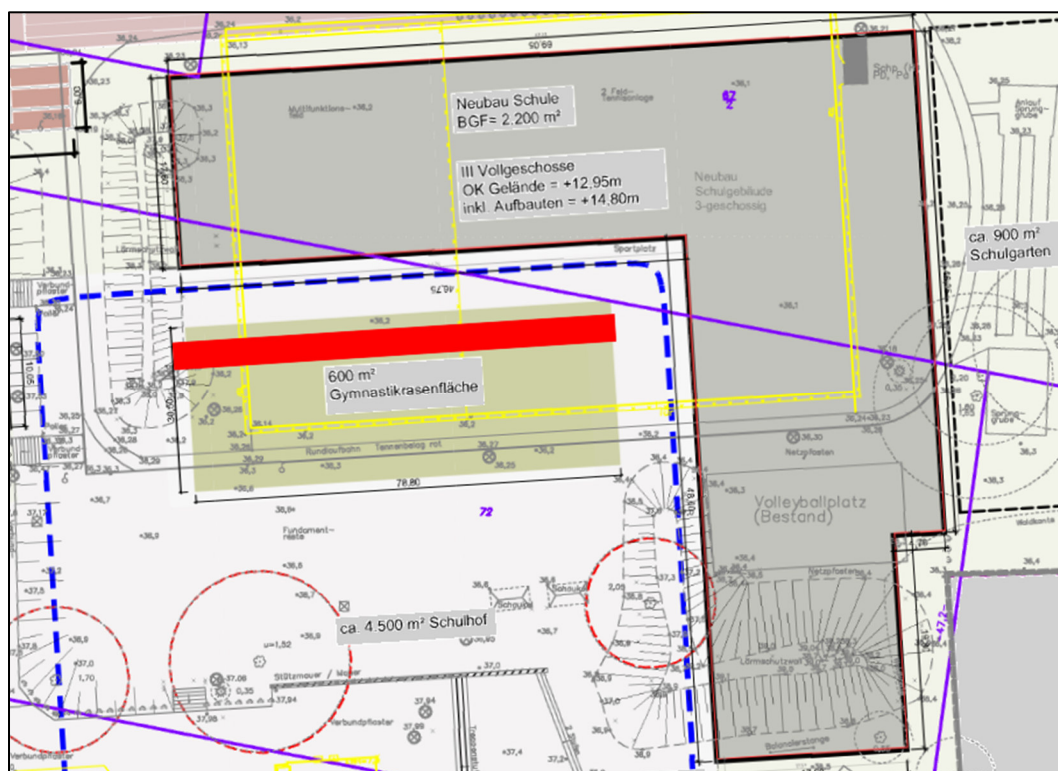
Lage Rigole Dachflächen – Neubau Schule Außenanlagenplanung Variante 1
